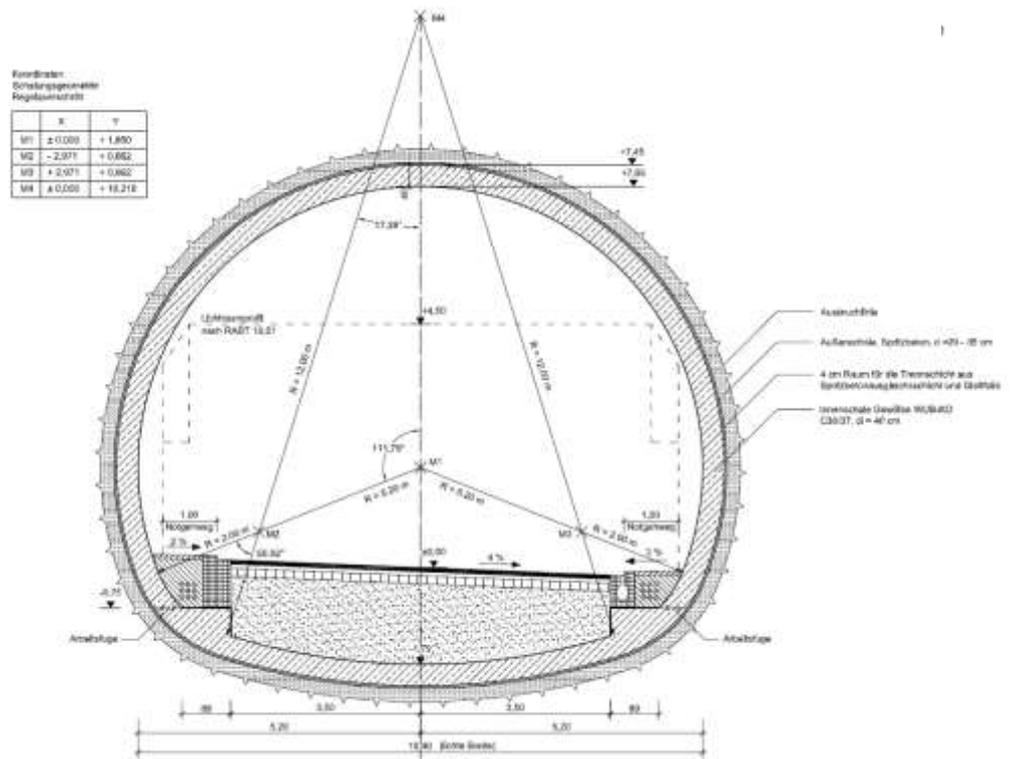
möglicher Querschnitt des Tunnelbauwerks
